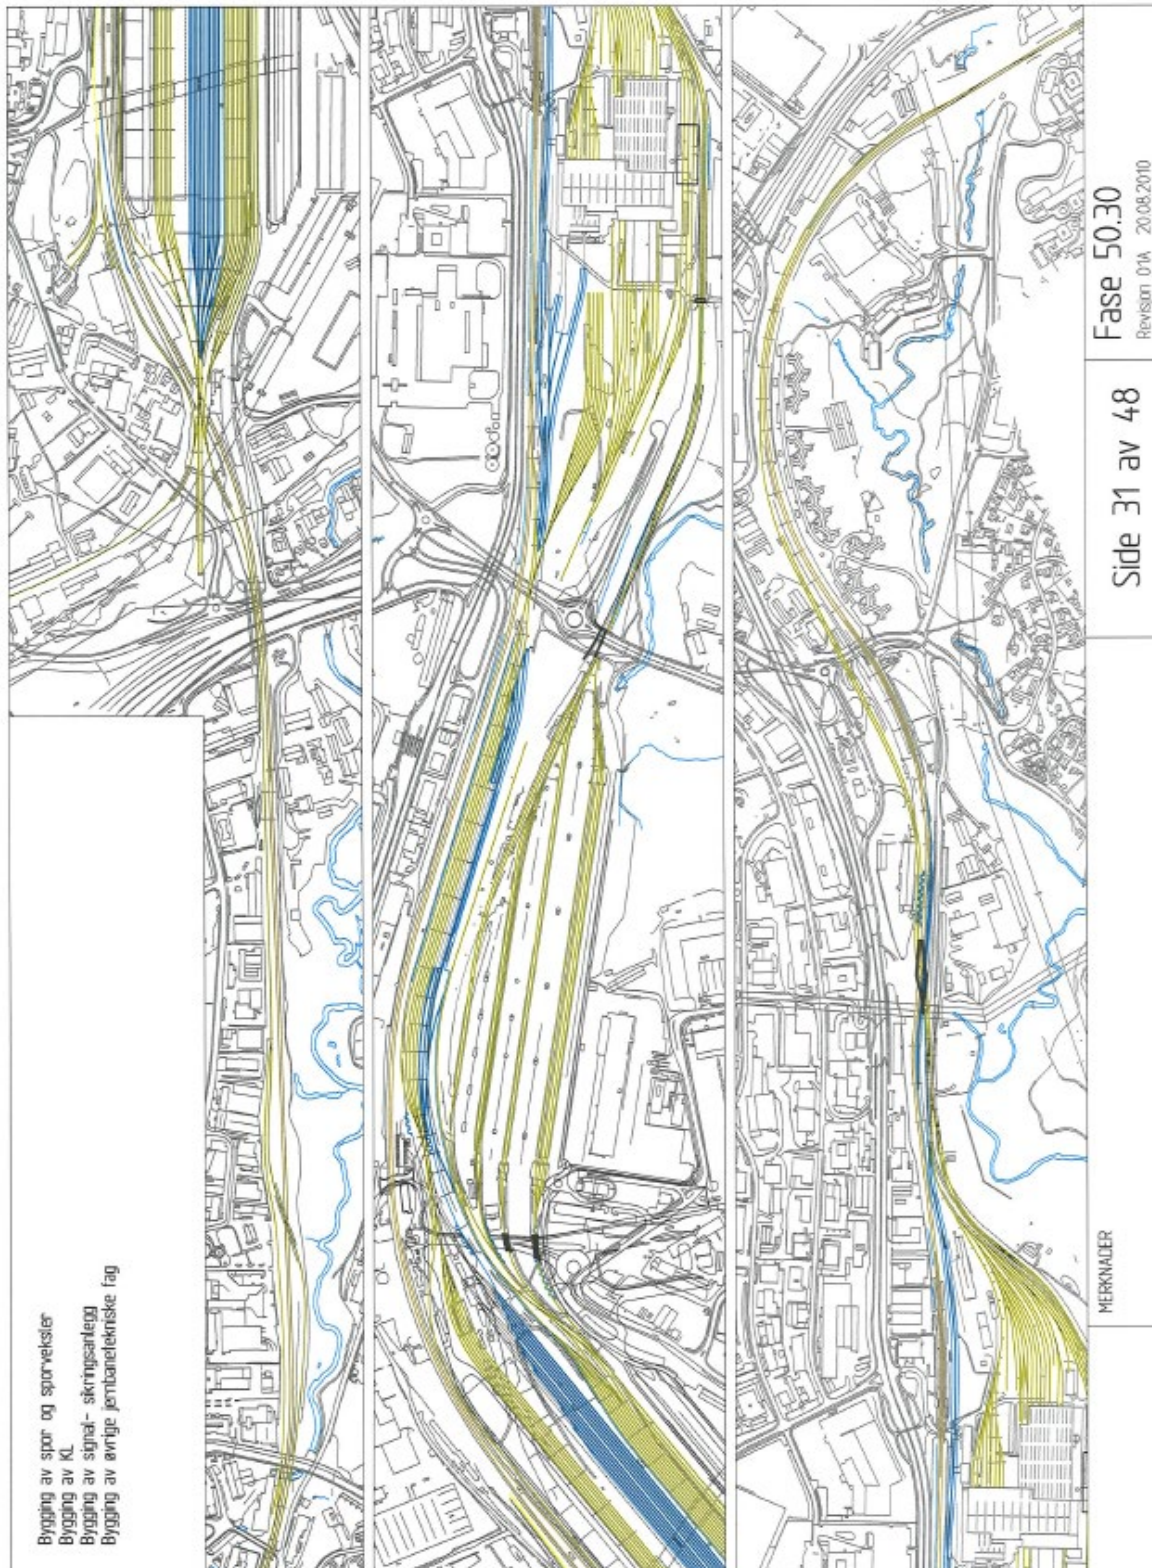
Utbygging konsept 4.8. Kilde: Hovedplan.
